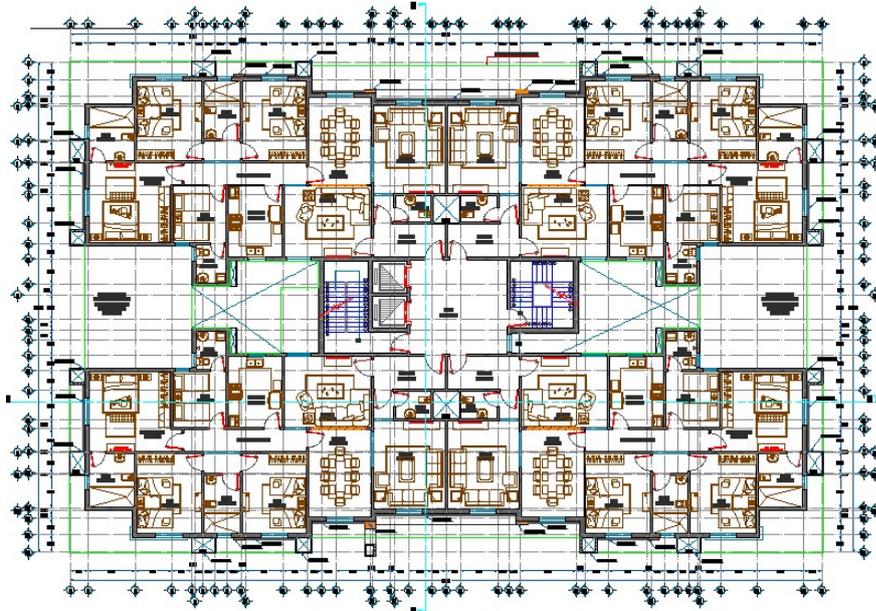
Planta arquitectónica de nivel tipo para el proyecto de edificios departamentales.
